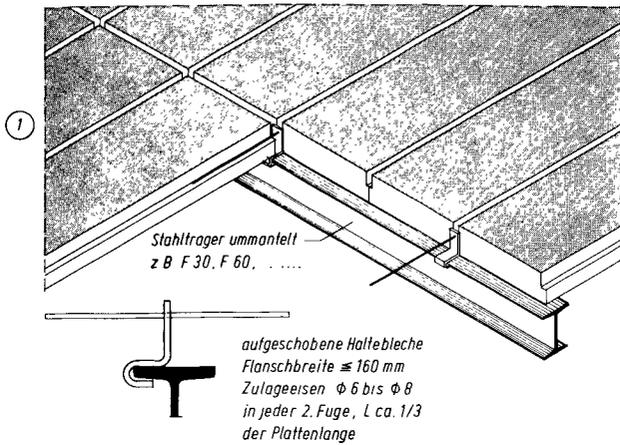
Auflagerung und Verlegung von Dach- und Deckenplatten – Schema für Halterungen
